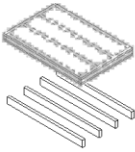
DETAILPUNKT AW-GD =EINBINDUNG DER GESCHOSSDECKE IN DIE AUSSENWAND
